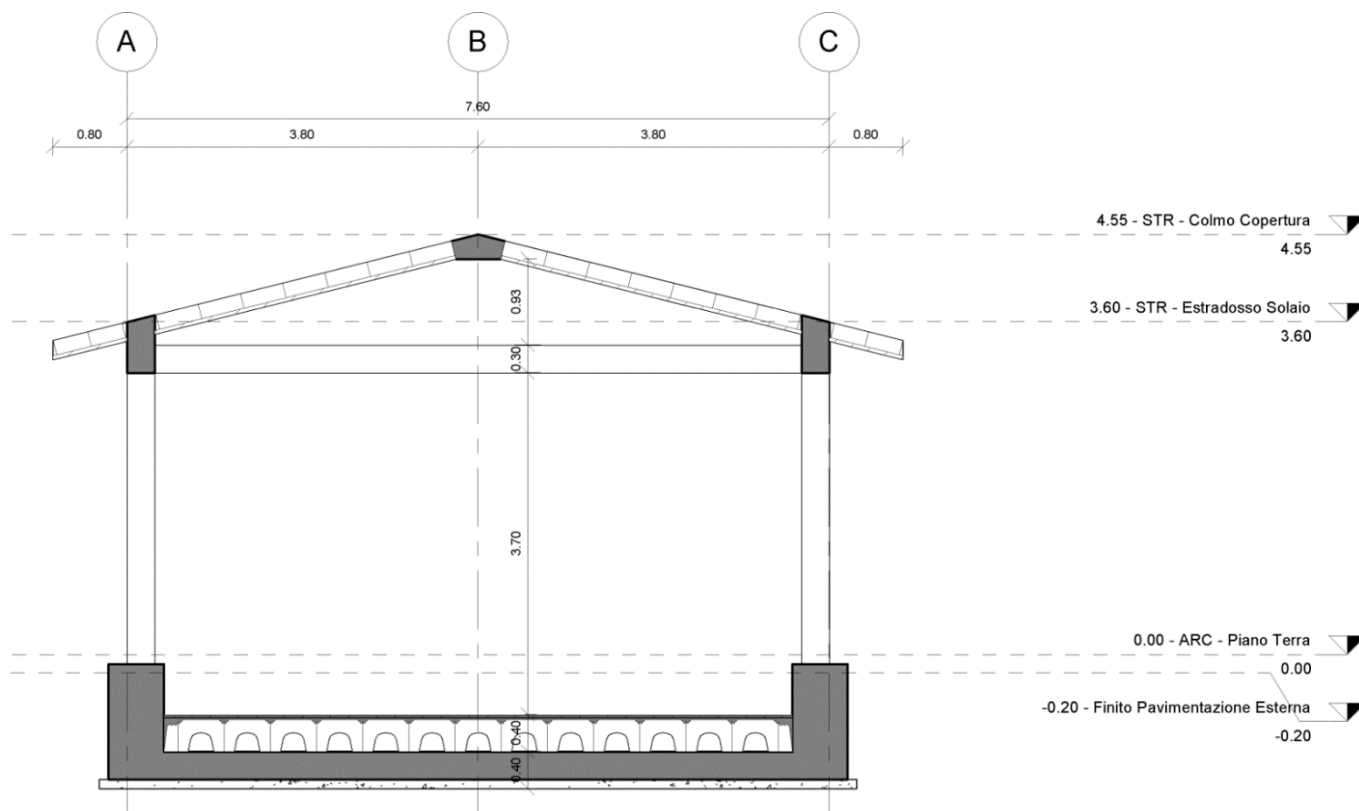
Fabbricato Tecnologico – Sezione Strutturale B - B
